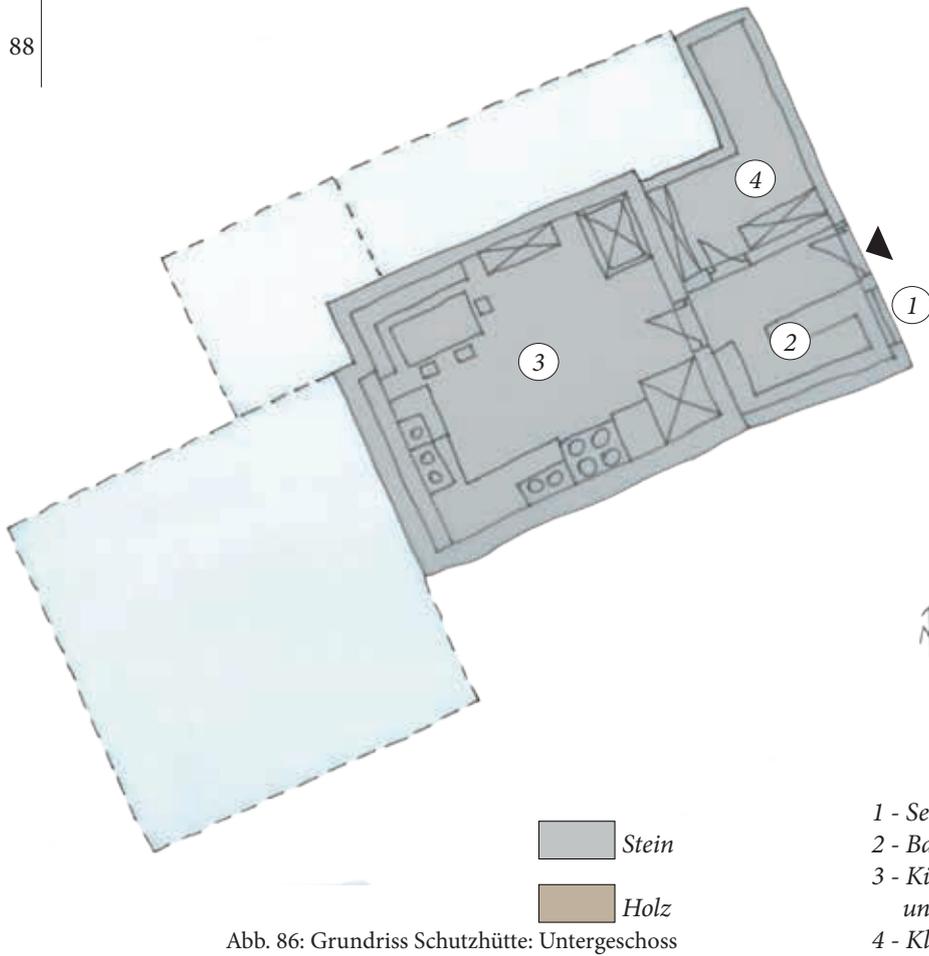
Grundriss Schutzhütte: Untergeschoss
